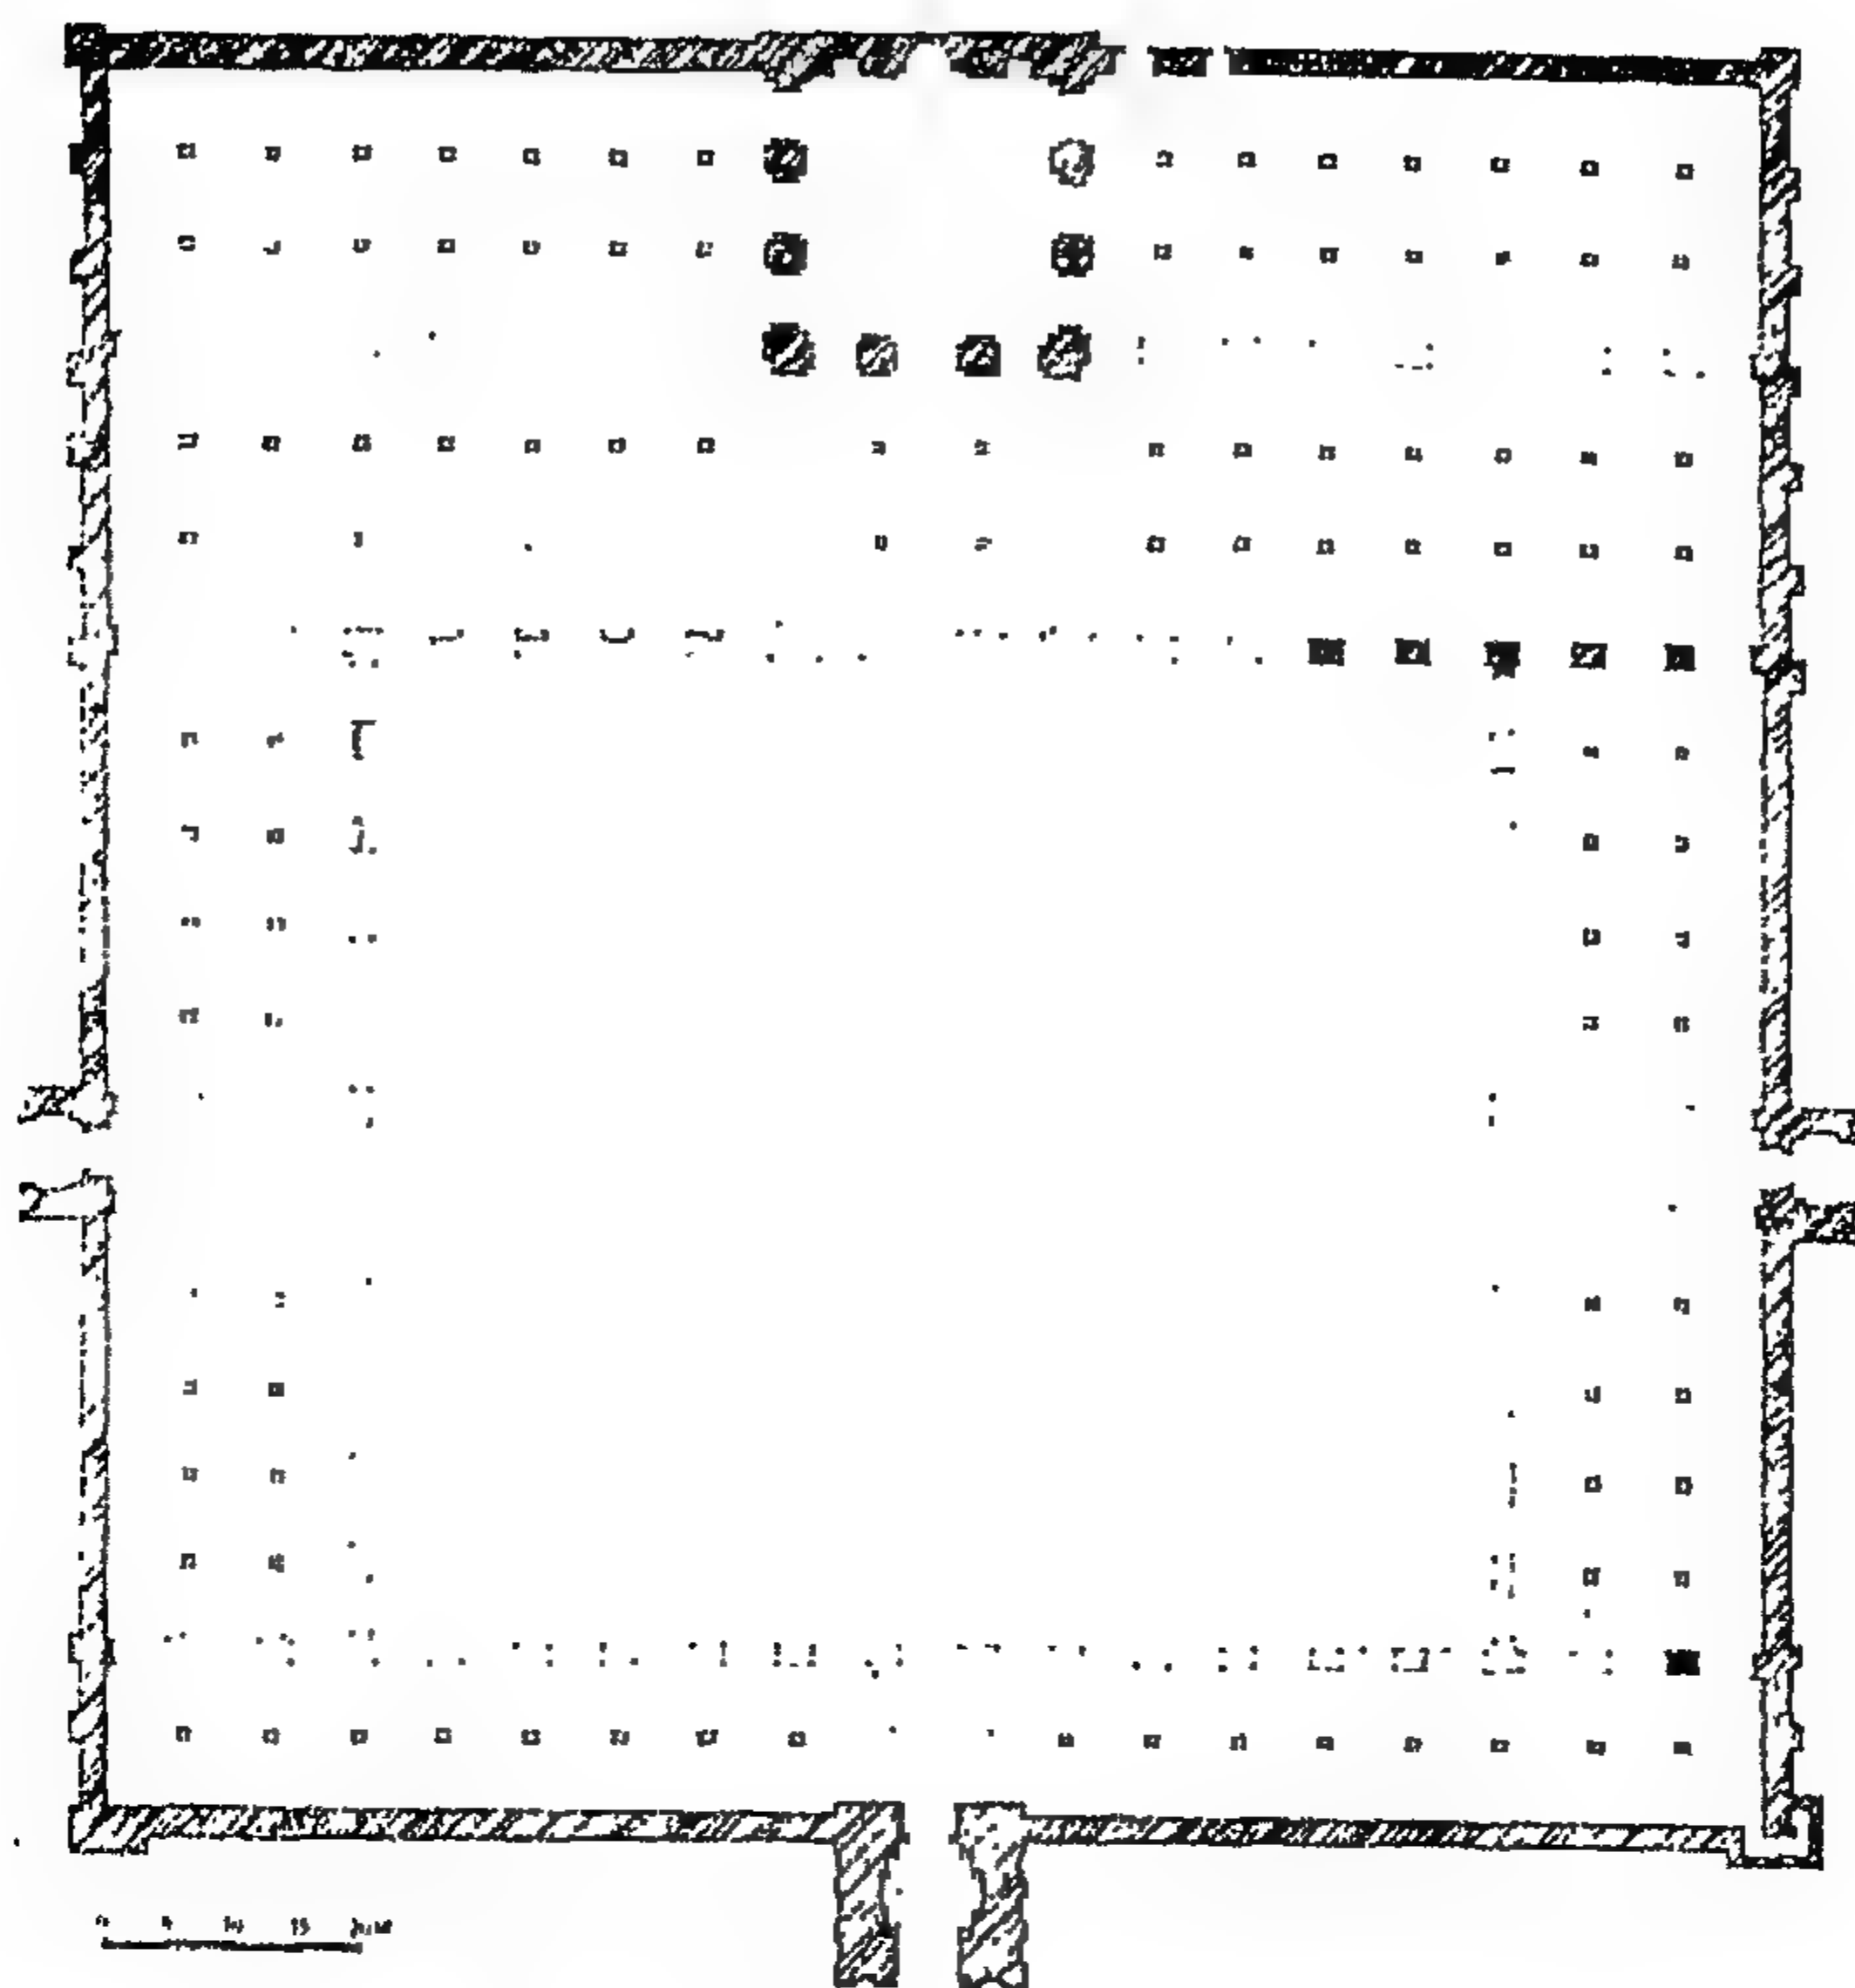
مسقط أفقي للجامع الأزهر في مرحلة إنشائه الأولى بالقاهرة (عن : هوج) .
